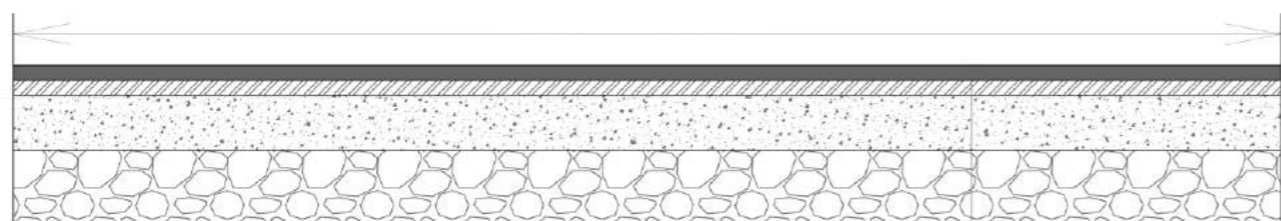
Příčný řez - dlažba (www.presbeton.cz)
